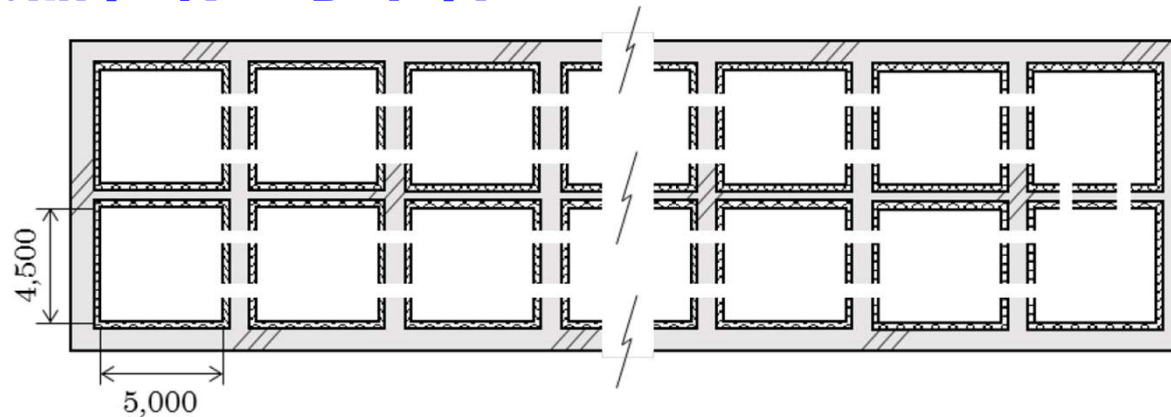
2 連結完全混合型水蓄熱槽 平面図
